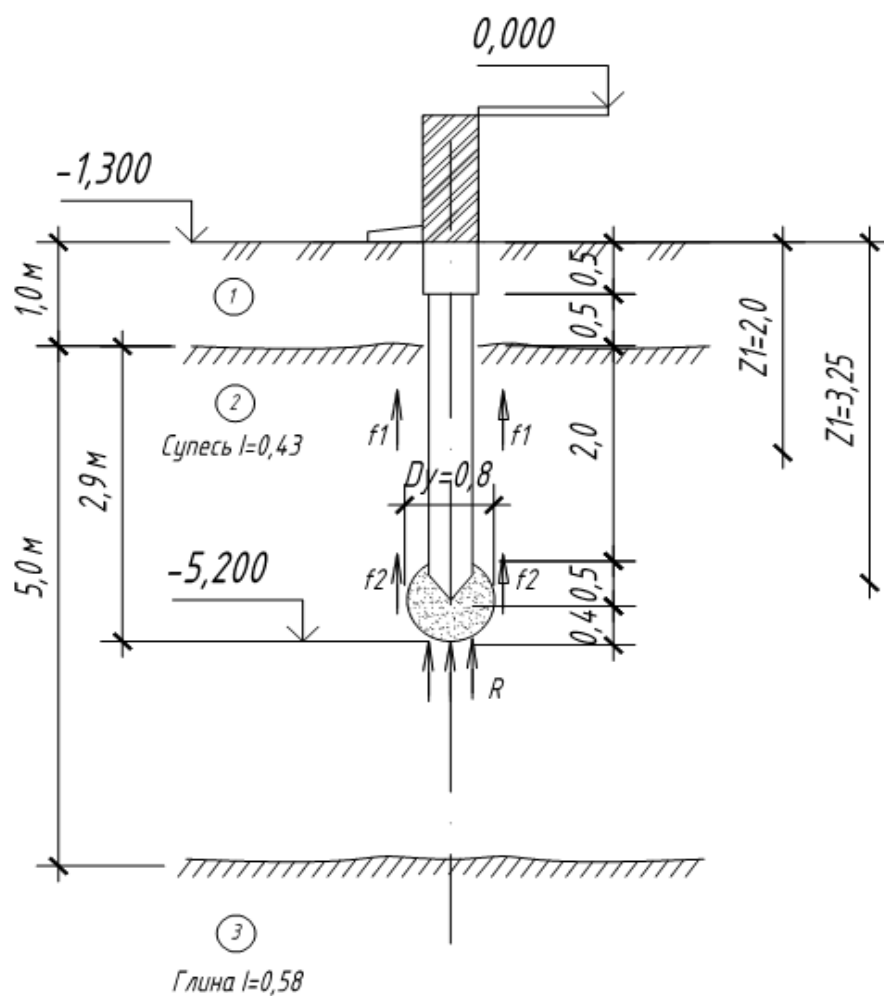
Разрез грунтовой толщи по СПС
